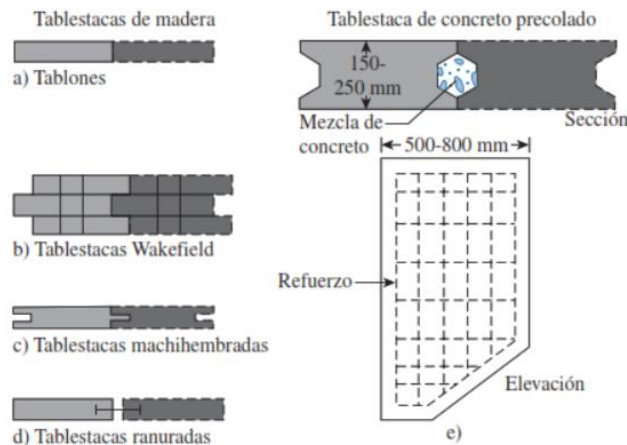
Tablestacas de madera y de concreto. Tomada de «Fundamentos de ingeniería de cimentaciones», por Braja, 2011, p. 438.
